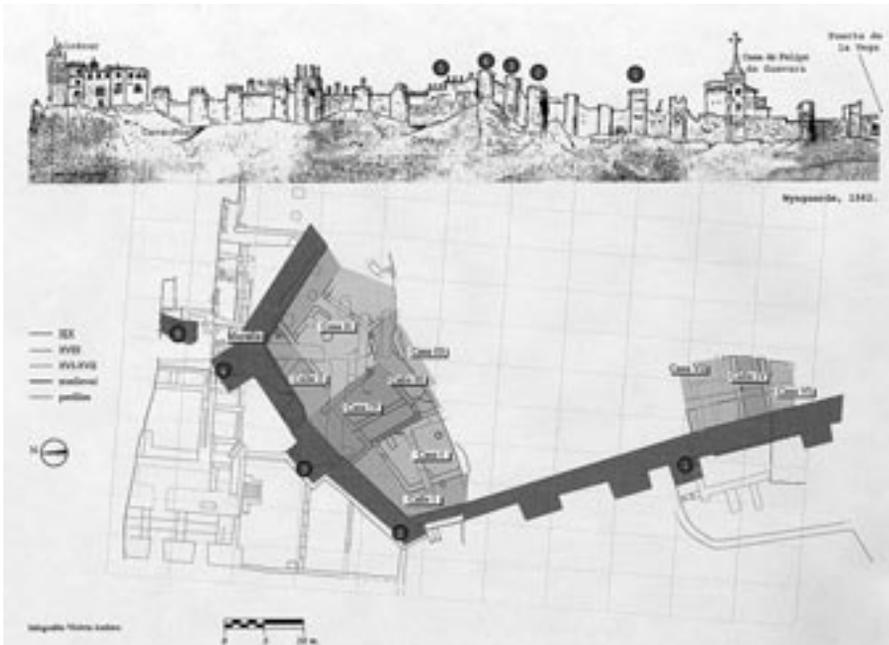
Plano de la excavación arqueológica de la plaza de la Armería.
